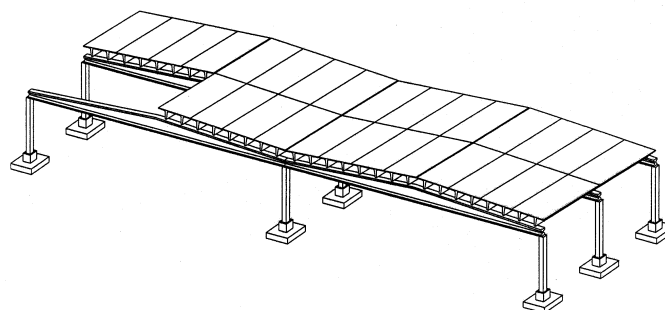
Portiekconstructie met lichte geribde dakelementen
